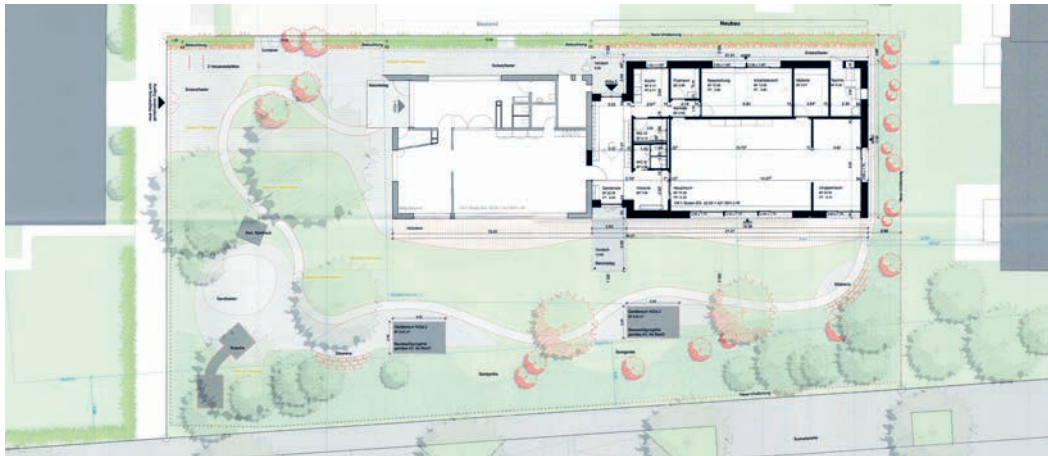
Grundriss Doppelkindergarten Baueingabe, GHZ Architekten AG
